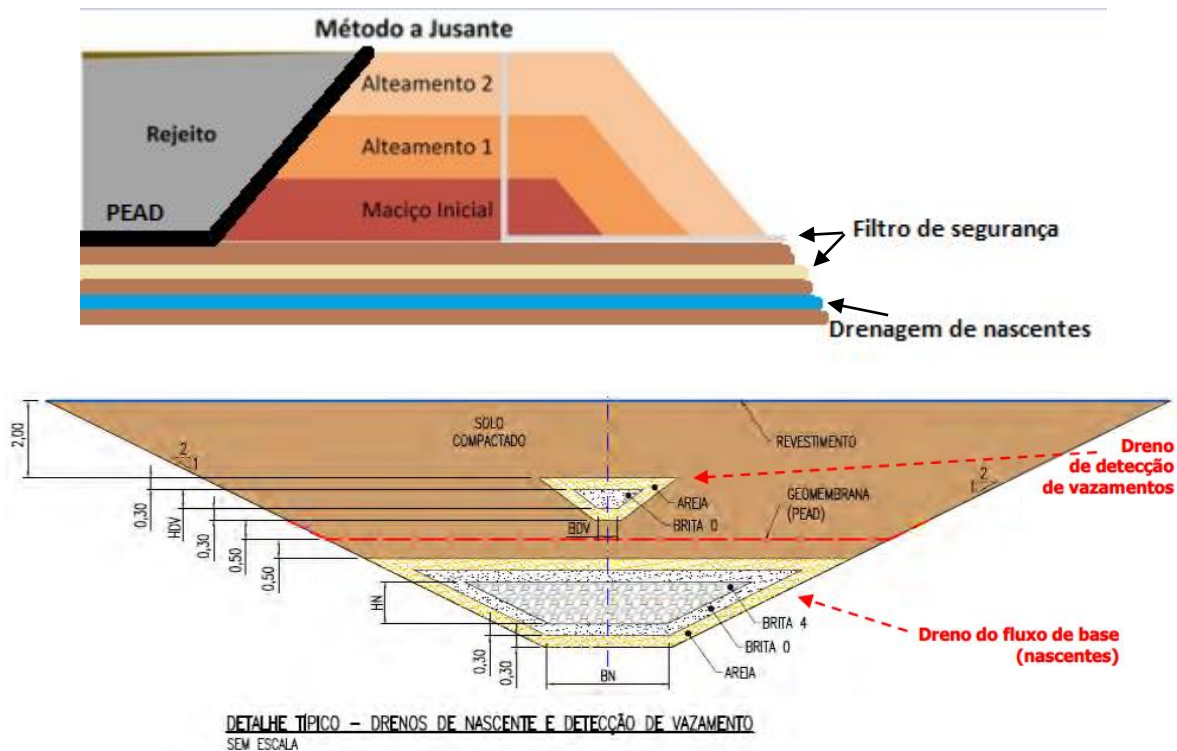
Método construtivo da barragem impermeabilizada e drenos.
